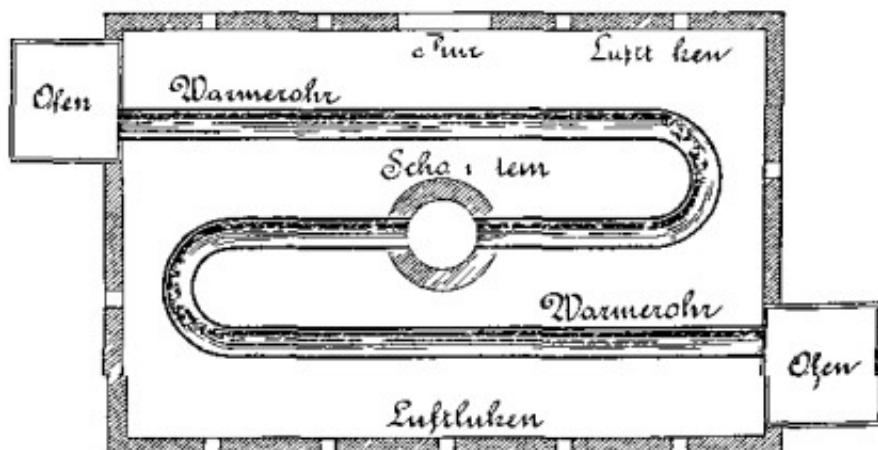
Grundriss eines Trockenhauses mit zwei Ofen und einem Schornstein in der Mitte
